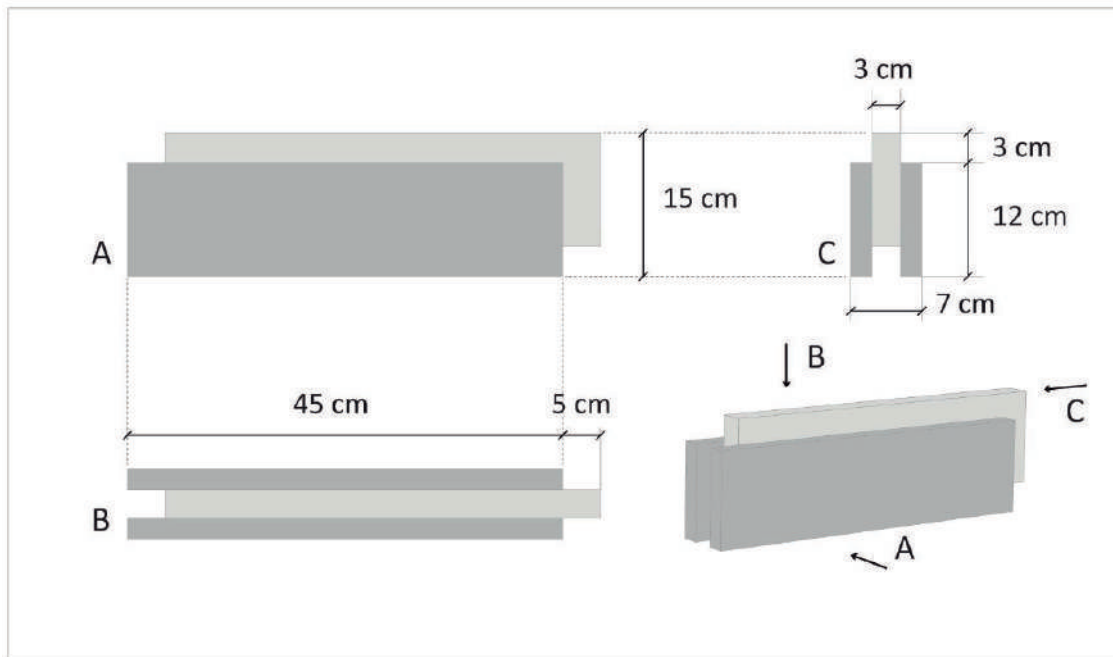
Bloques arquitectónicos macizos de plástico reciclado. De izquierda a derecha: bloque estructural; bloque no estructural; ensamblaje ambas piezas. Fuente: elaboración propia
